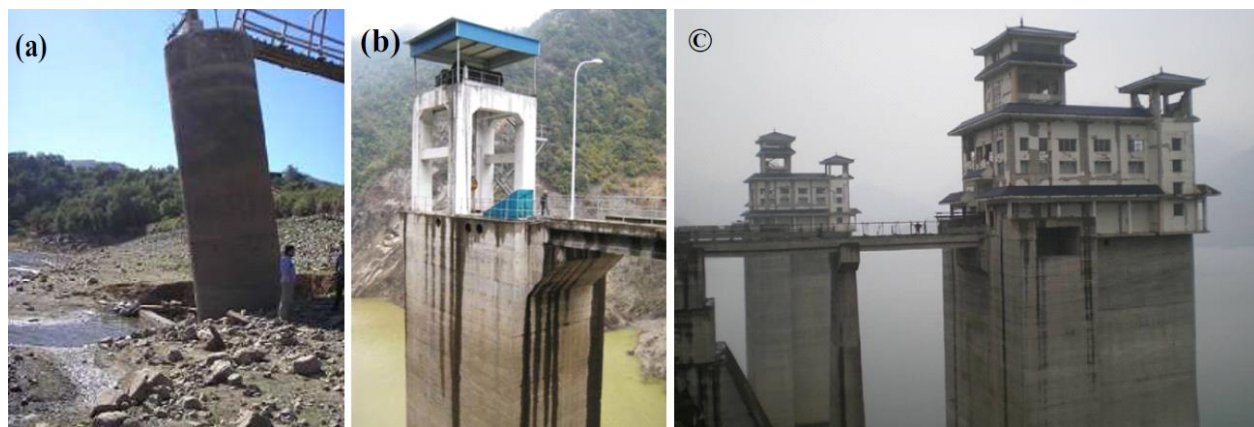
(a) Séisme du Chili – février 2010 : renversement de la tour de prise d’eau (photo N. Noguera); (b) Séisme de Wenchuan (Chine) - mai 2008 : fissures sur le portique de la tour de prise d’eau du barrage Shapai (MEDDE-DGPR, 2014); (c) Séisme de Wenchuan (Chine) - mai 2008 : endommagement d’un bâtiment en béton sur la tour de prise d’eau du barrage de Zipingpu (ICOLD, 2012).
